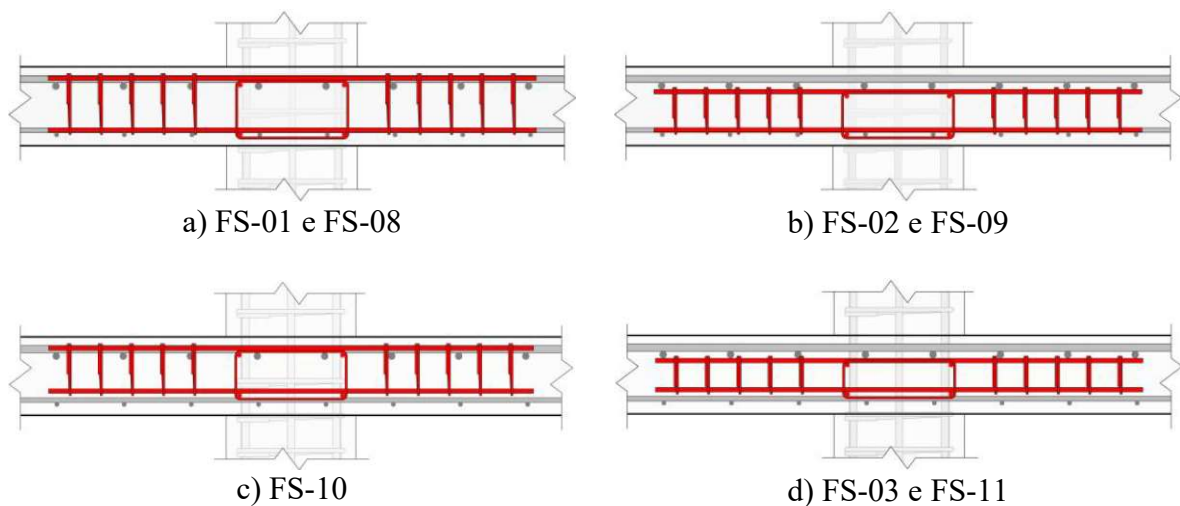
Resumo das características das lajes ensaiadas, adaptado de Palhares (2018) e Souza (2018).
